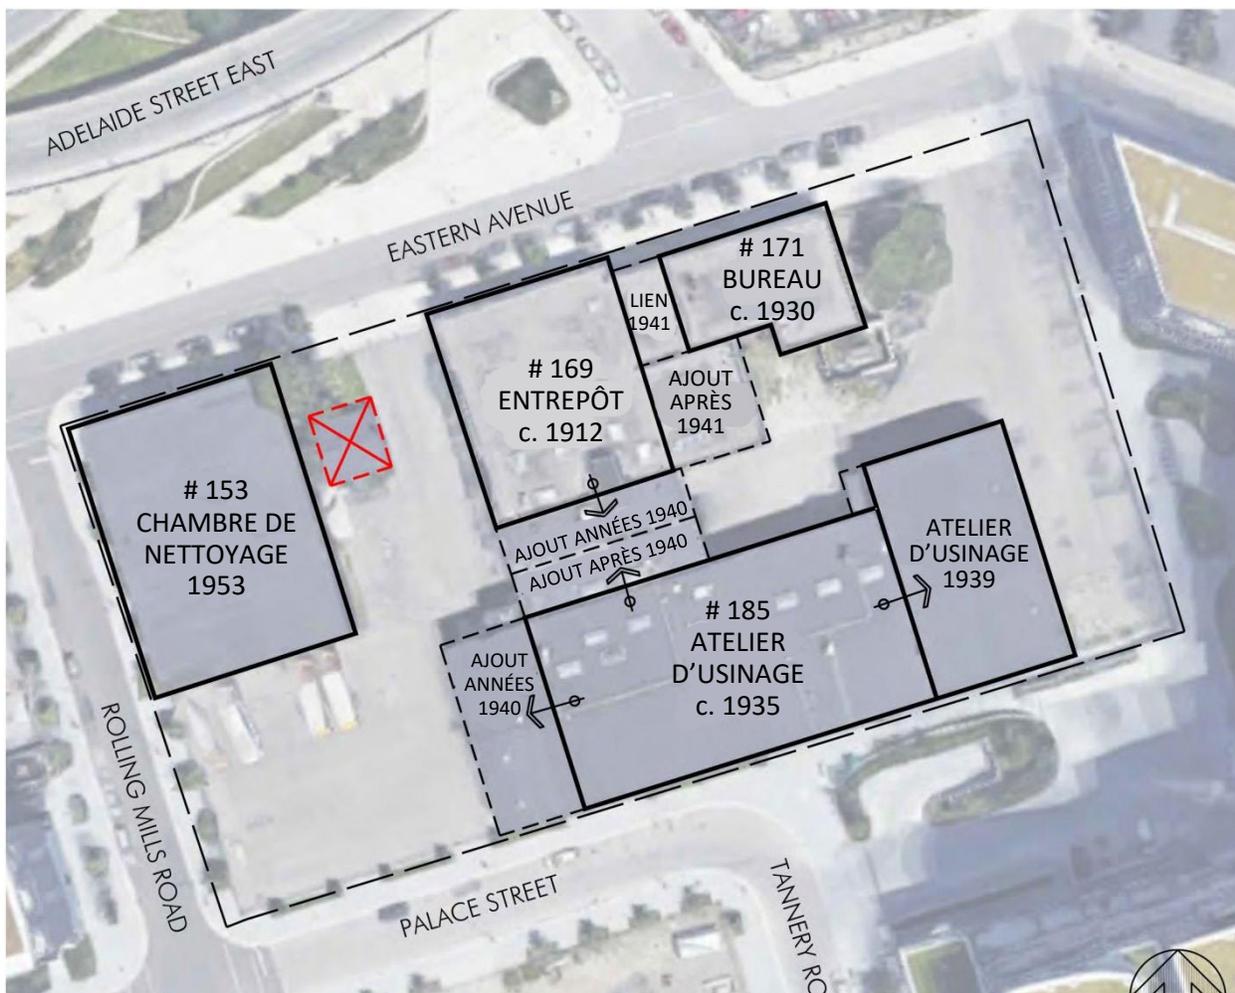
Plan du site du complexe de la fonderie montrant les bâtiments, les ajouts et les dates de construction.
